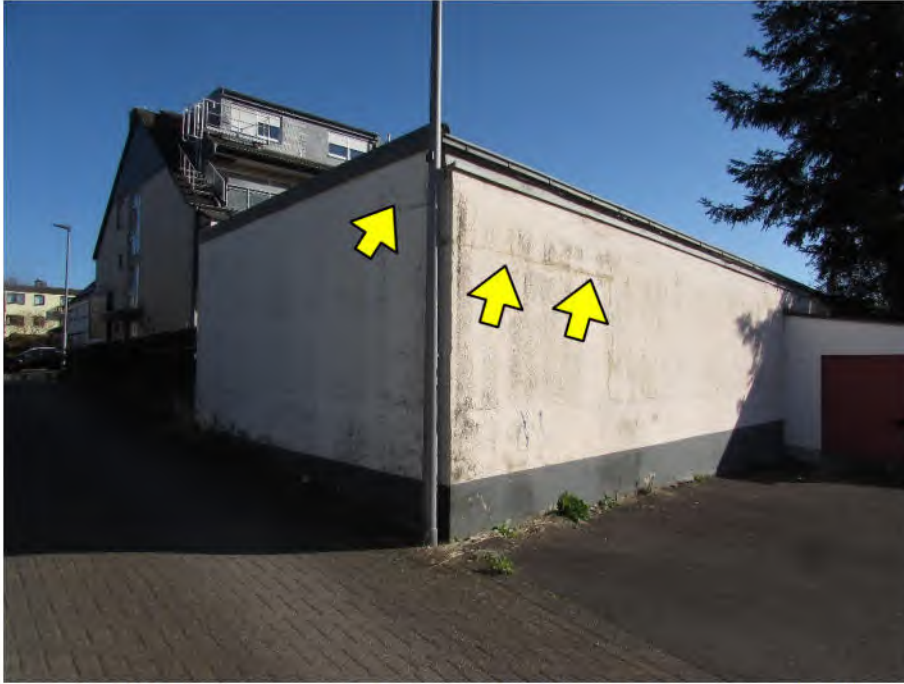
PKW-Garagen, rückwärtige Ansicht: fleckige Fassade, Risse
